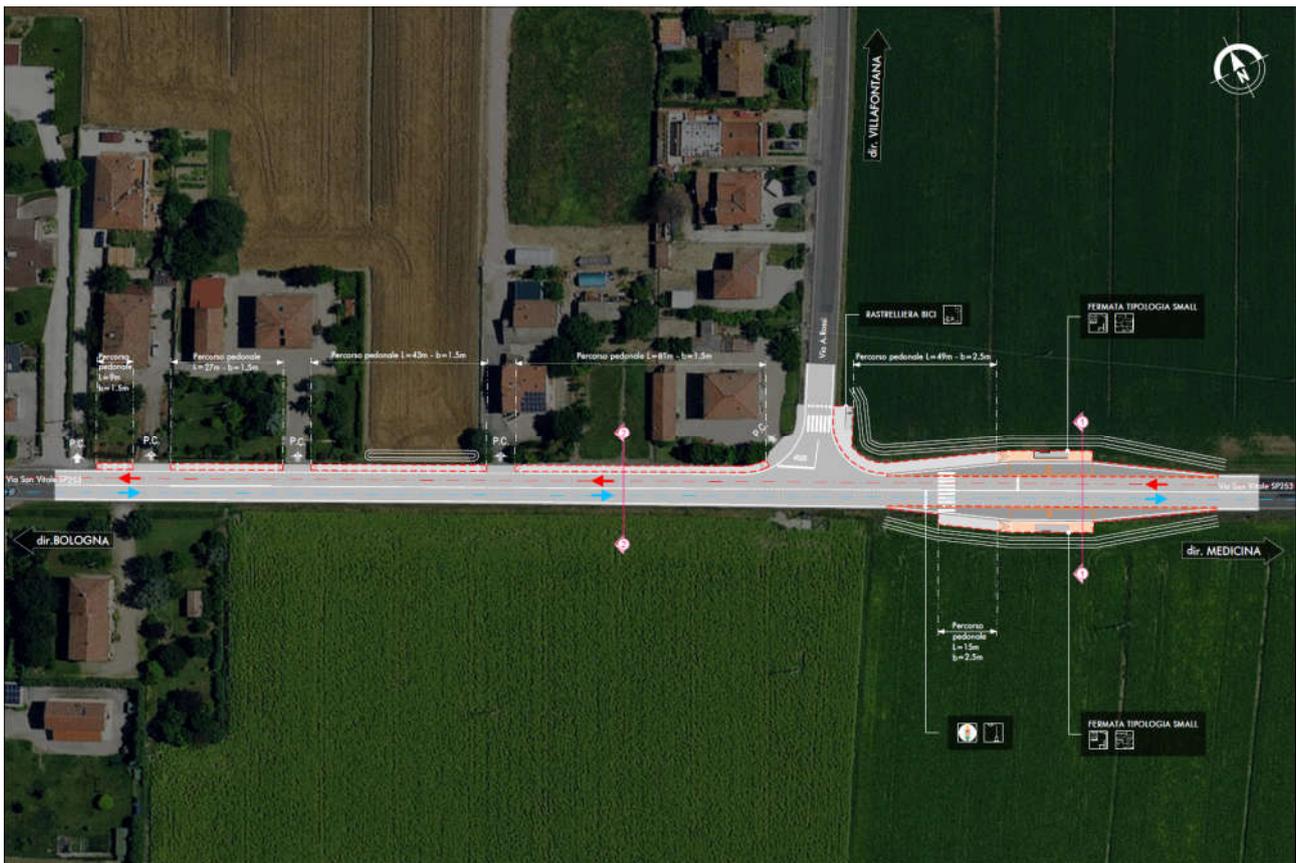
Fermata Bivio Rossi. Planimetria.
